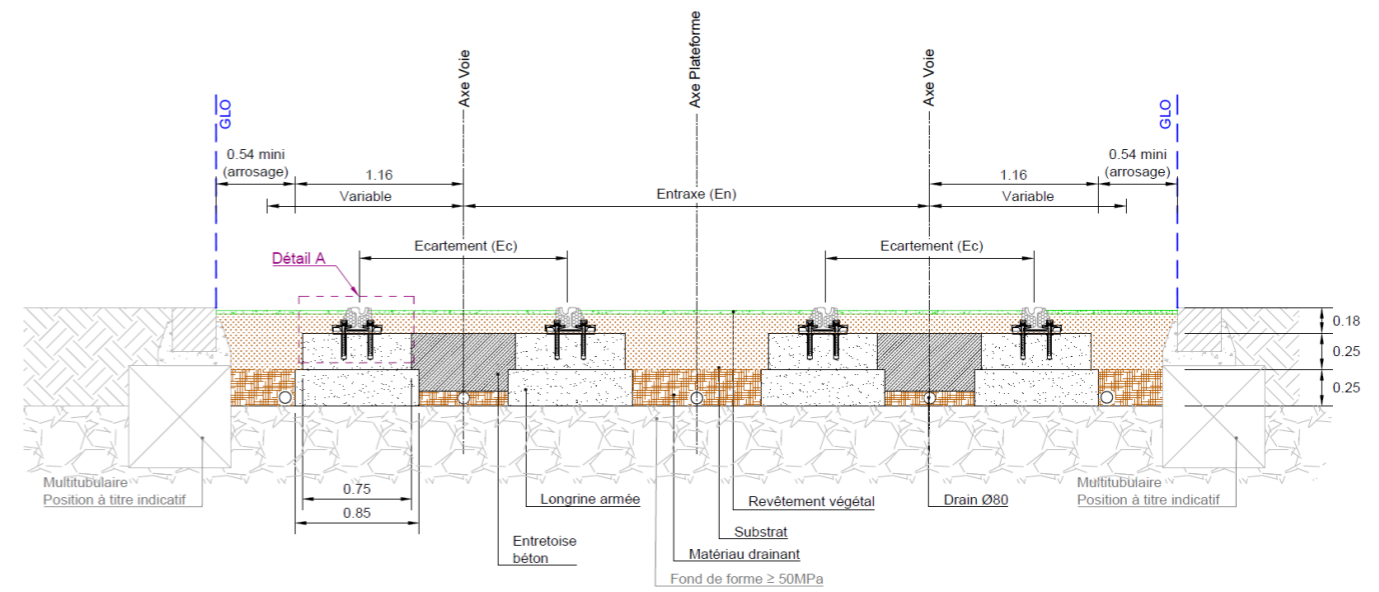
coupe type d'une plateforme pour voie sur longrines - Revêtement végétal
